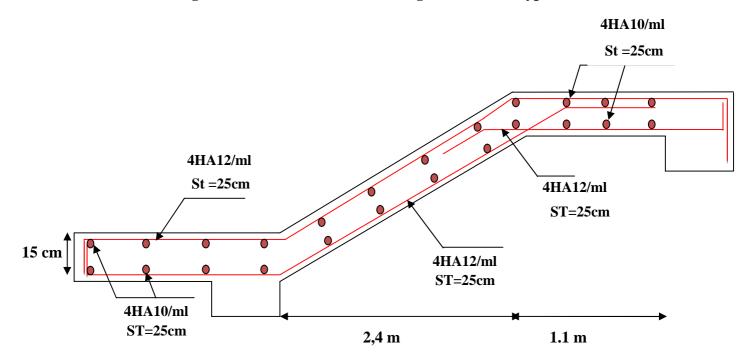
Schéma de ferraillage de l'escalier type 2
